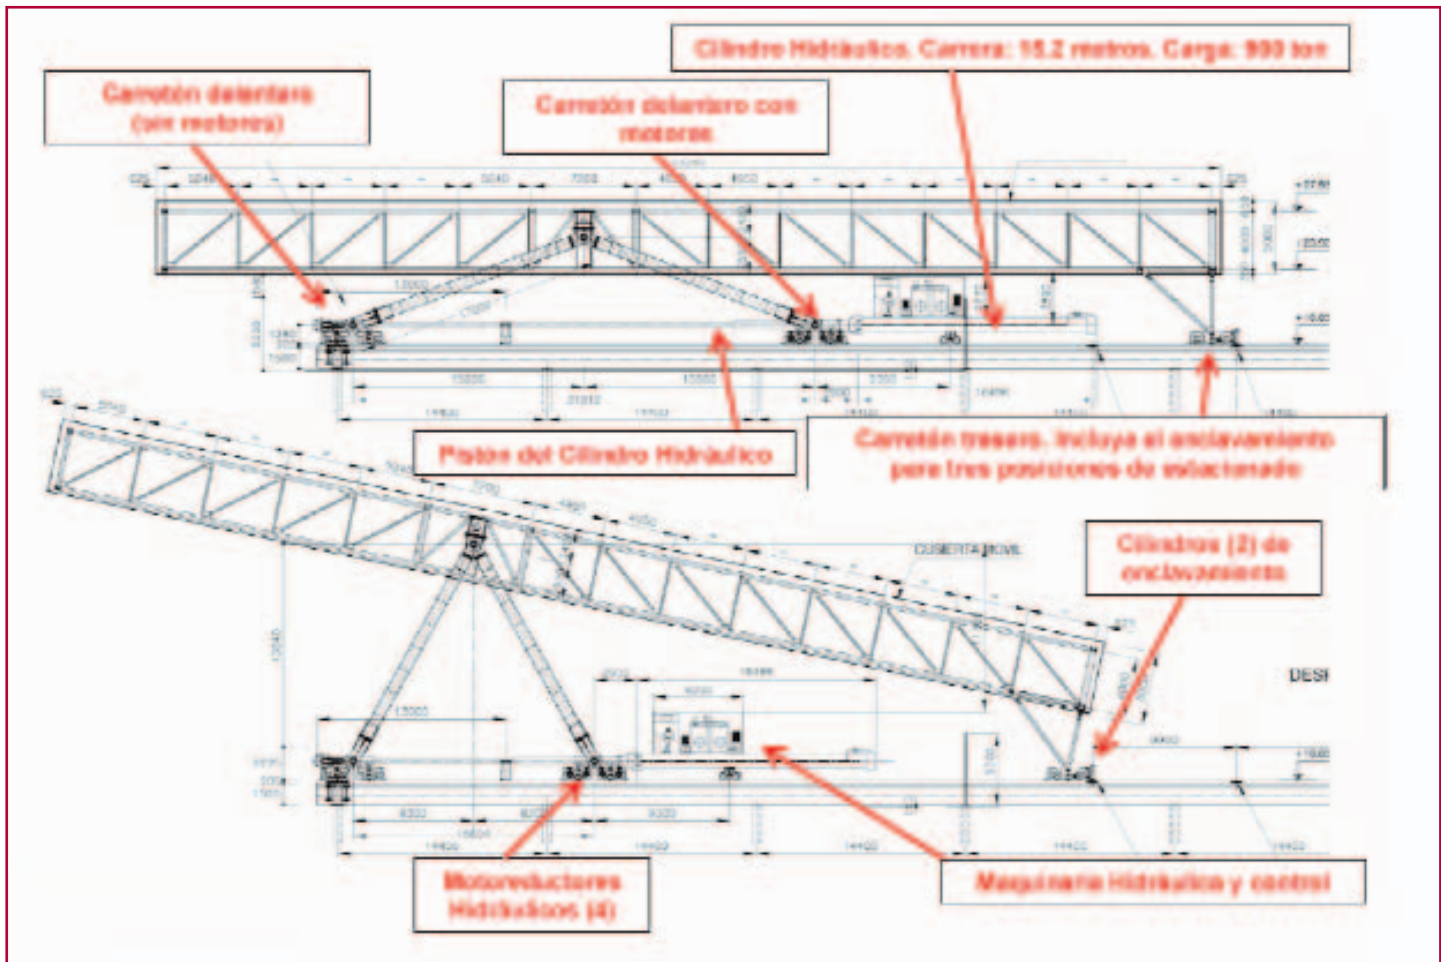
Sistema de desplazamiento y elevación Cubierta 1.
